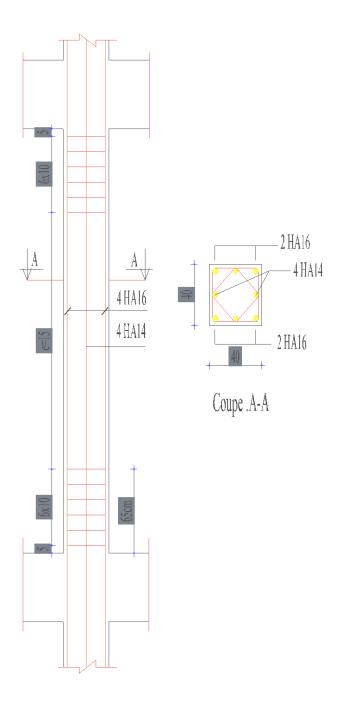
Schéma de ferraillage des poteaux (40 x 40)
